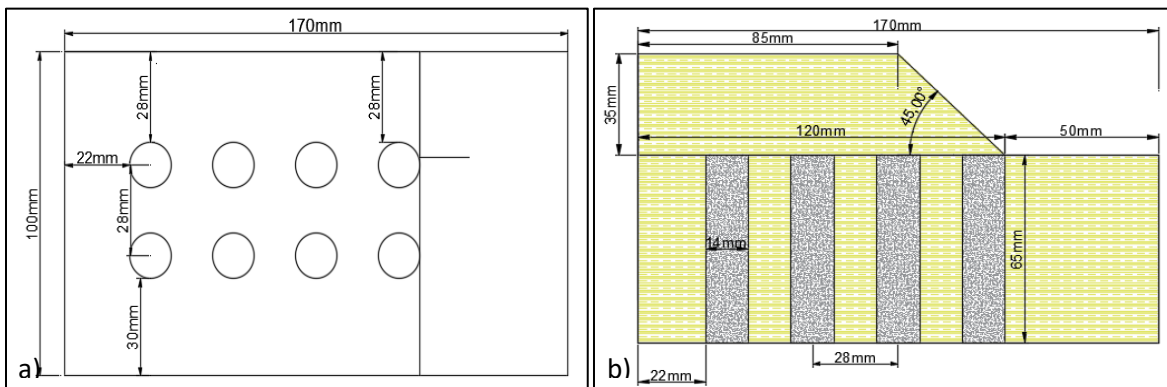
En a) vista en planta, en b) sección transversal de la distribución de columnas de suelo cemento de diámetro 1.4 m en el prototipo
